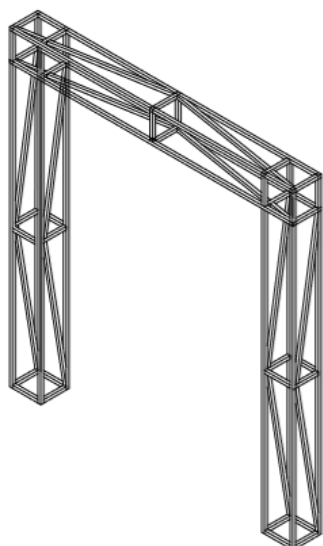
Perspetiva da estrutura metálica - proposta para a exposição temporária
